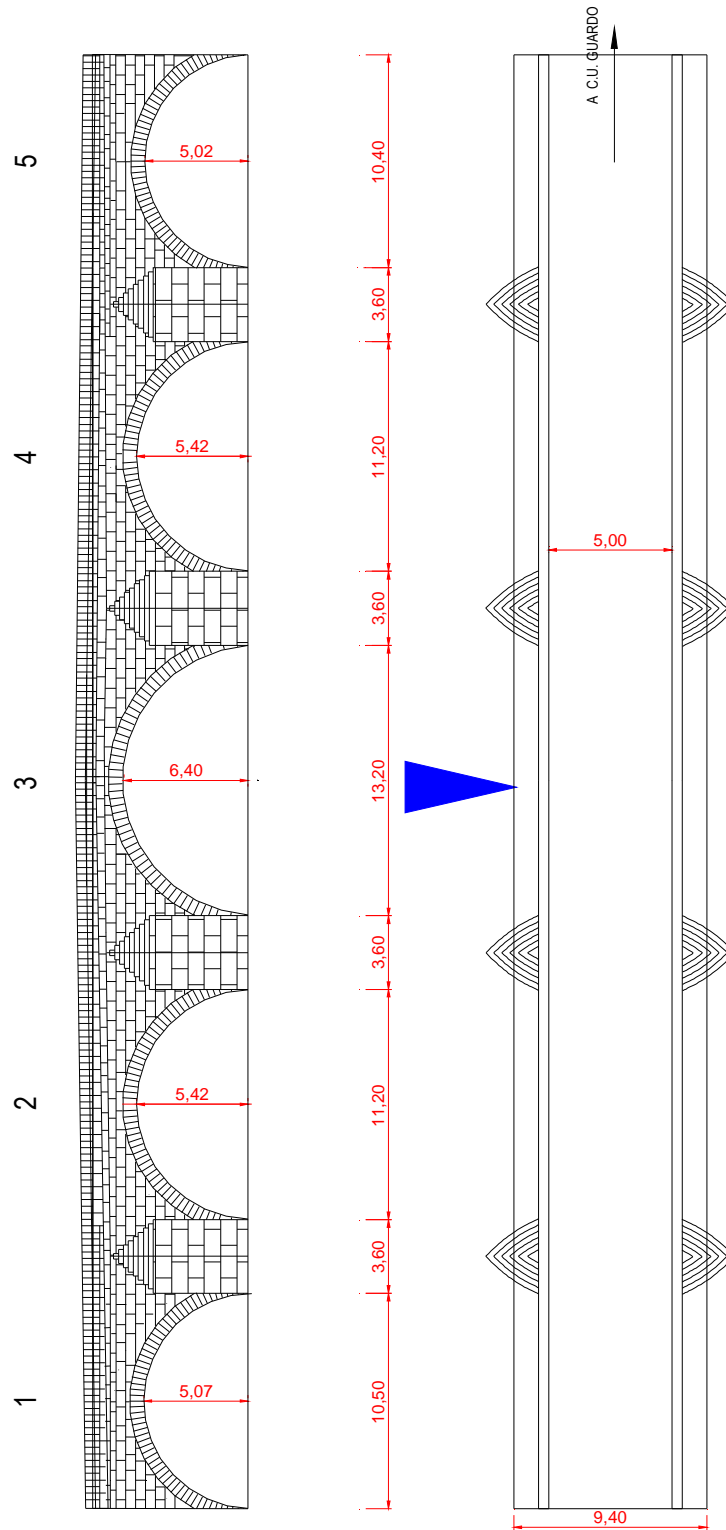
Planta y alzado de aguas arriba del puente en Guardo
